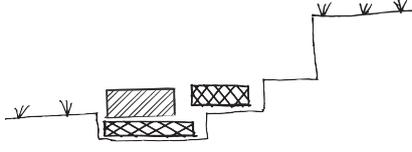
Einbau Beton-Blockstufen; Fa. Cavigelli Gartenbau
